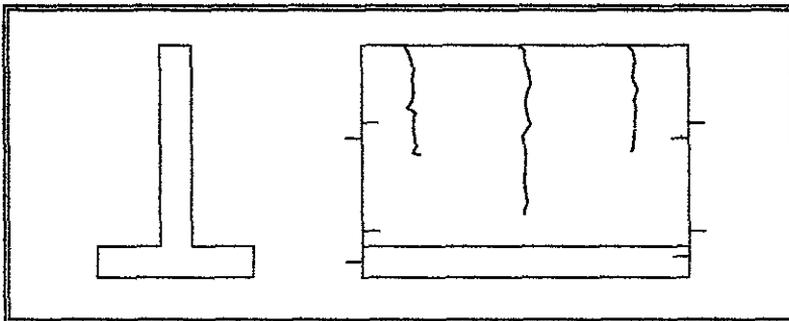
Daños por contracción hidráulica en un muro de contención.
